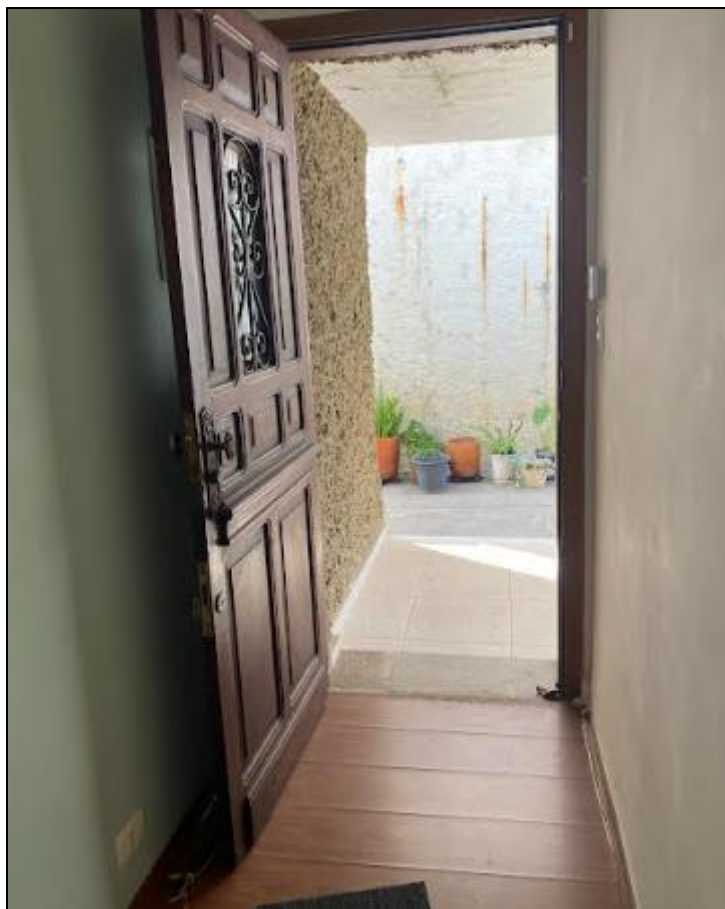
DETALHE PORTA DE ENTRADA INDICANDO IDADE DA EDIFICAÇÃO.
